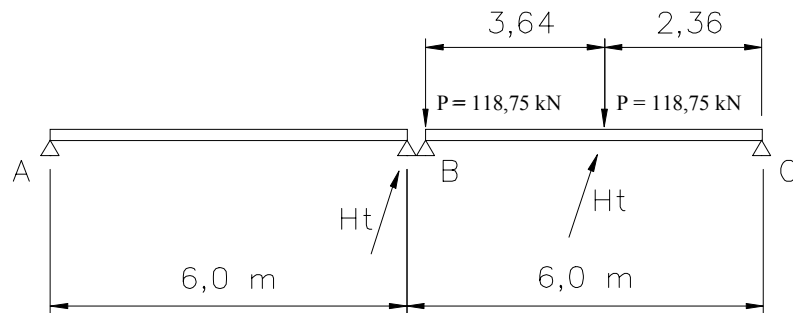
Ponte rolante posicionada sobre o caminho de rolamento
